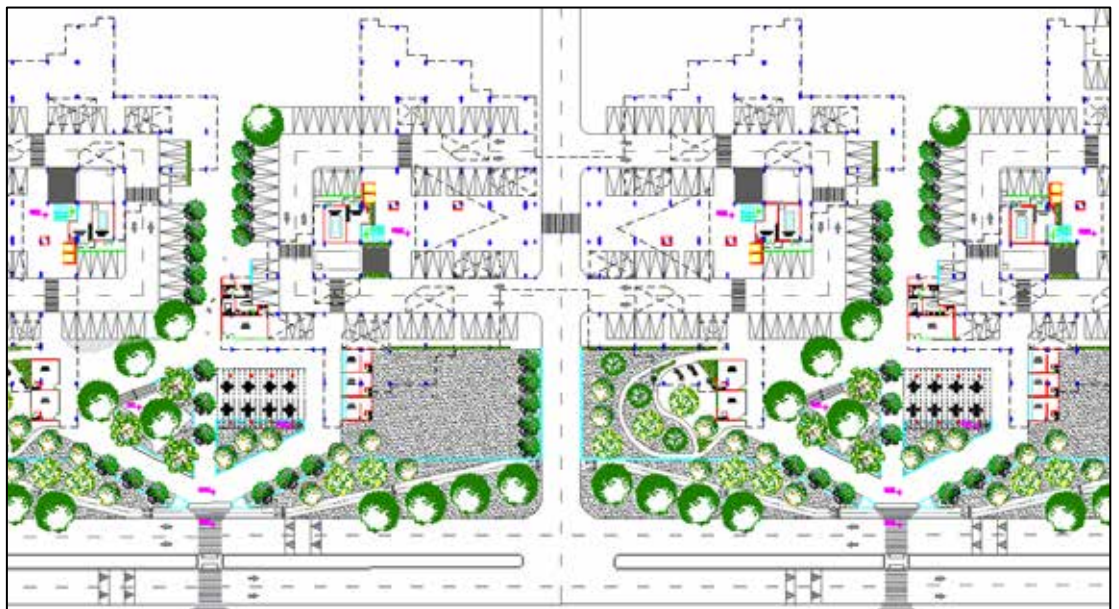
Planta de baja de conjunto vivienda multifamiliar
